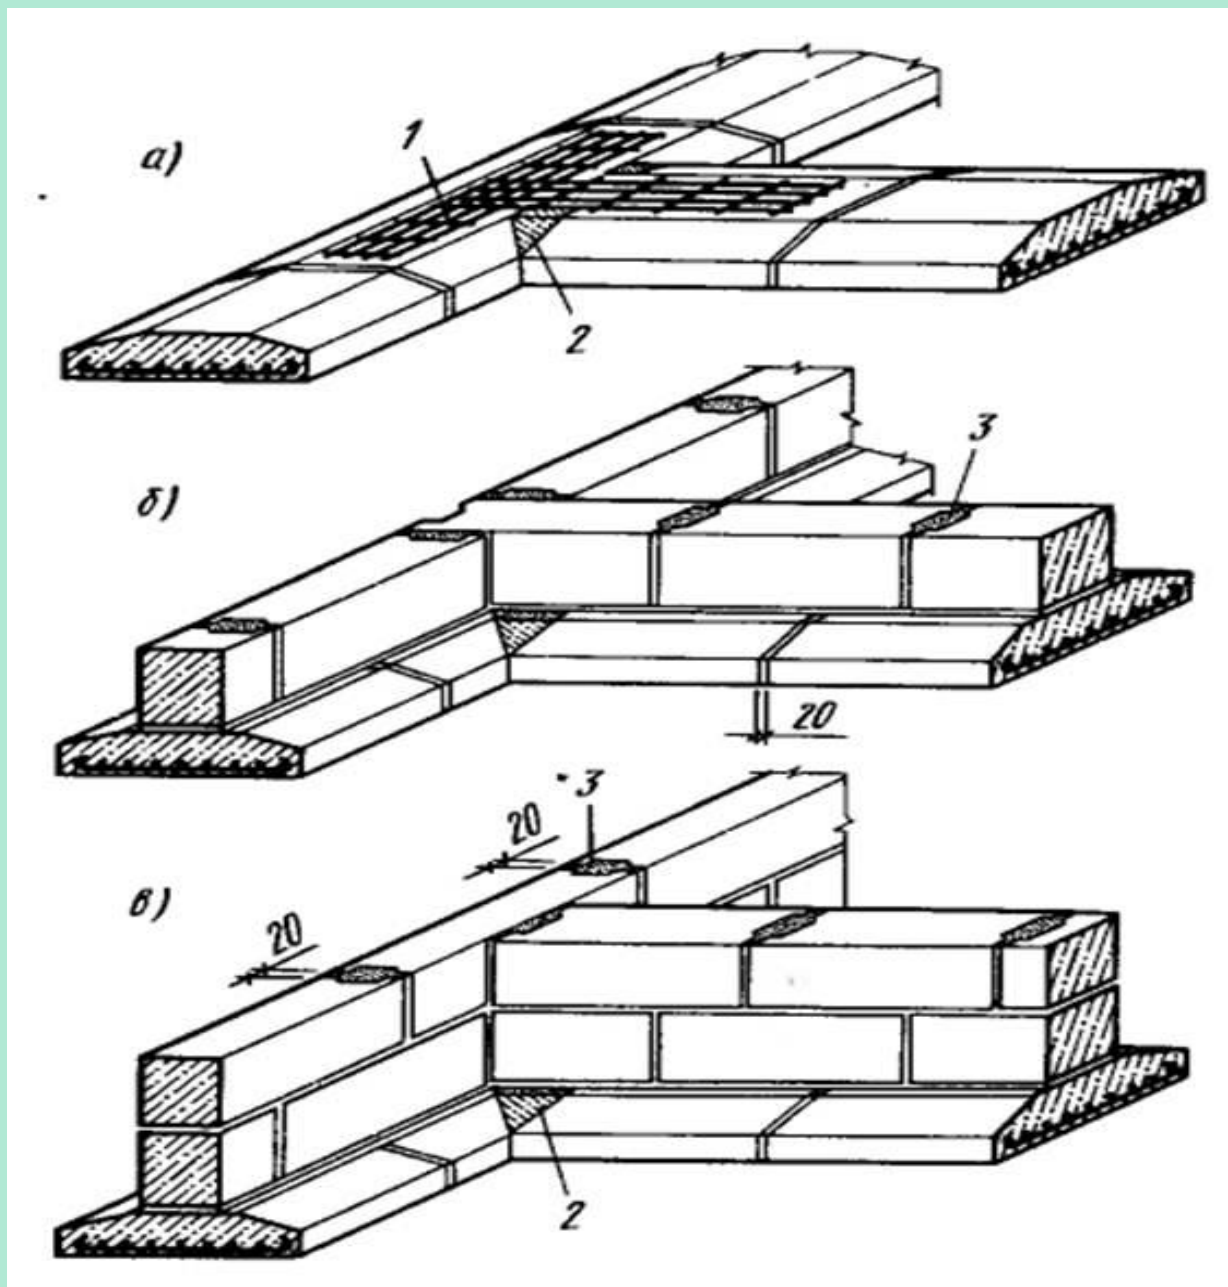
Минимальная глубина перевязки вертикальных швов фундаментных стеновых блоков:
